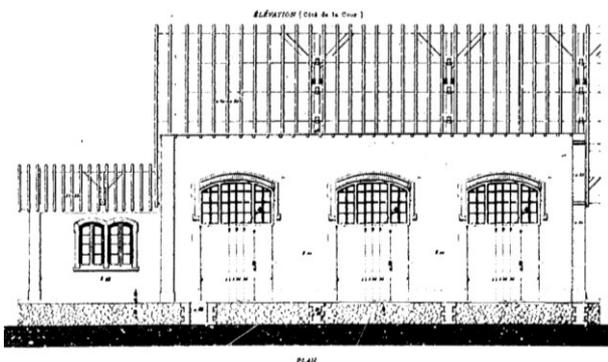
Prospetto della Halle Marchandise Gare de la Gare de St. Amand. Fonte: blog di collezionista privato, Jean-Claude Drion
